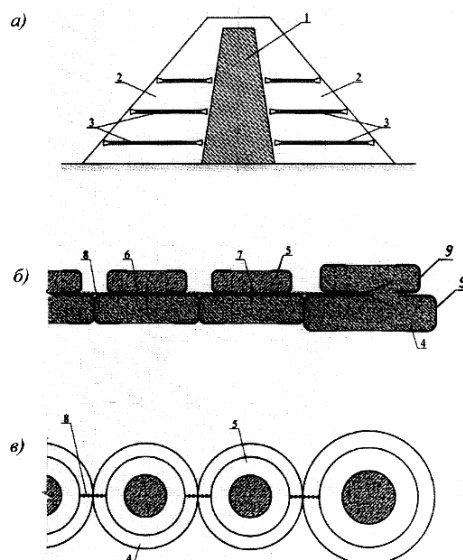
Сейсмостойкая грунтовая плотина, поперечный разрез
